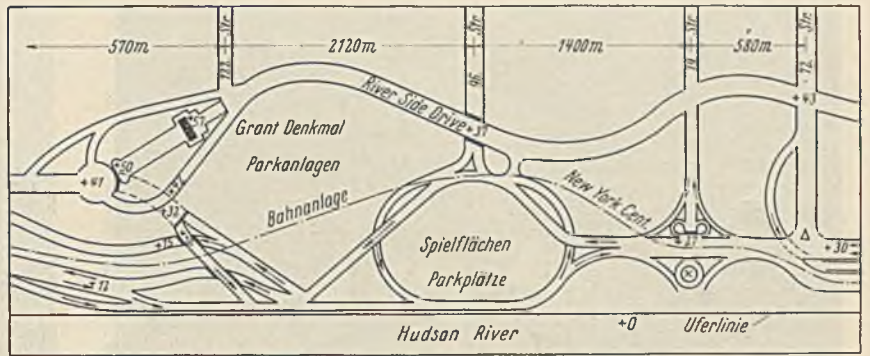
Neue Hudson-Ufer-Hochstraße. Verzerrter Lageplan.
